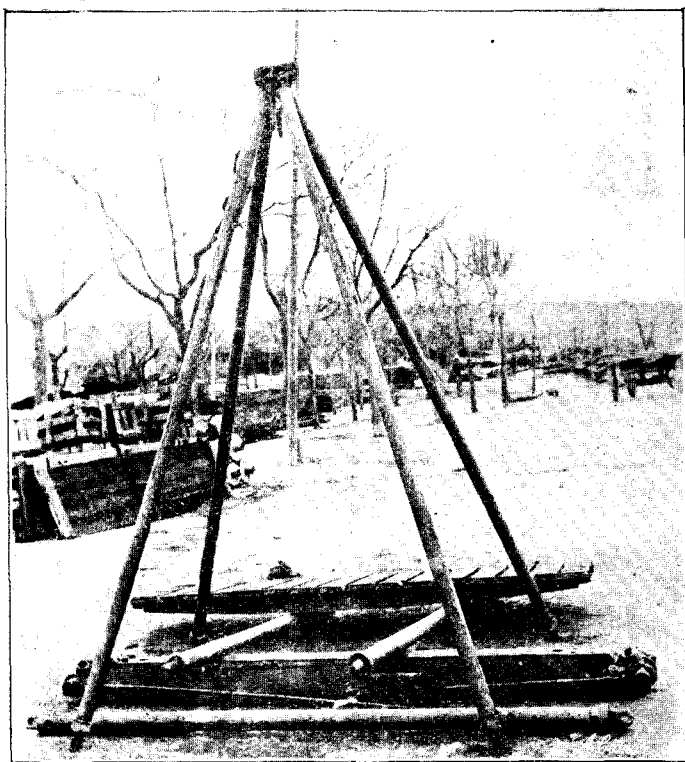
Vista de las piezas constitutivas de un tramo.
